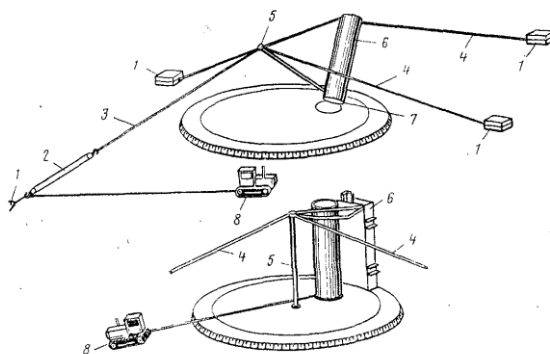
Схема зборки резервуара з рулонних заготовок; а — под'єм рулону корпусу; б — разгортання рулону; 1 — опори; 2 — полиспаст 3 — под'ємний трос; 4 — страховочні троси; 5 — опорна стійка; 6 — рулон резервуара; 7 - днище; 8 — трактора
